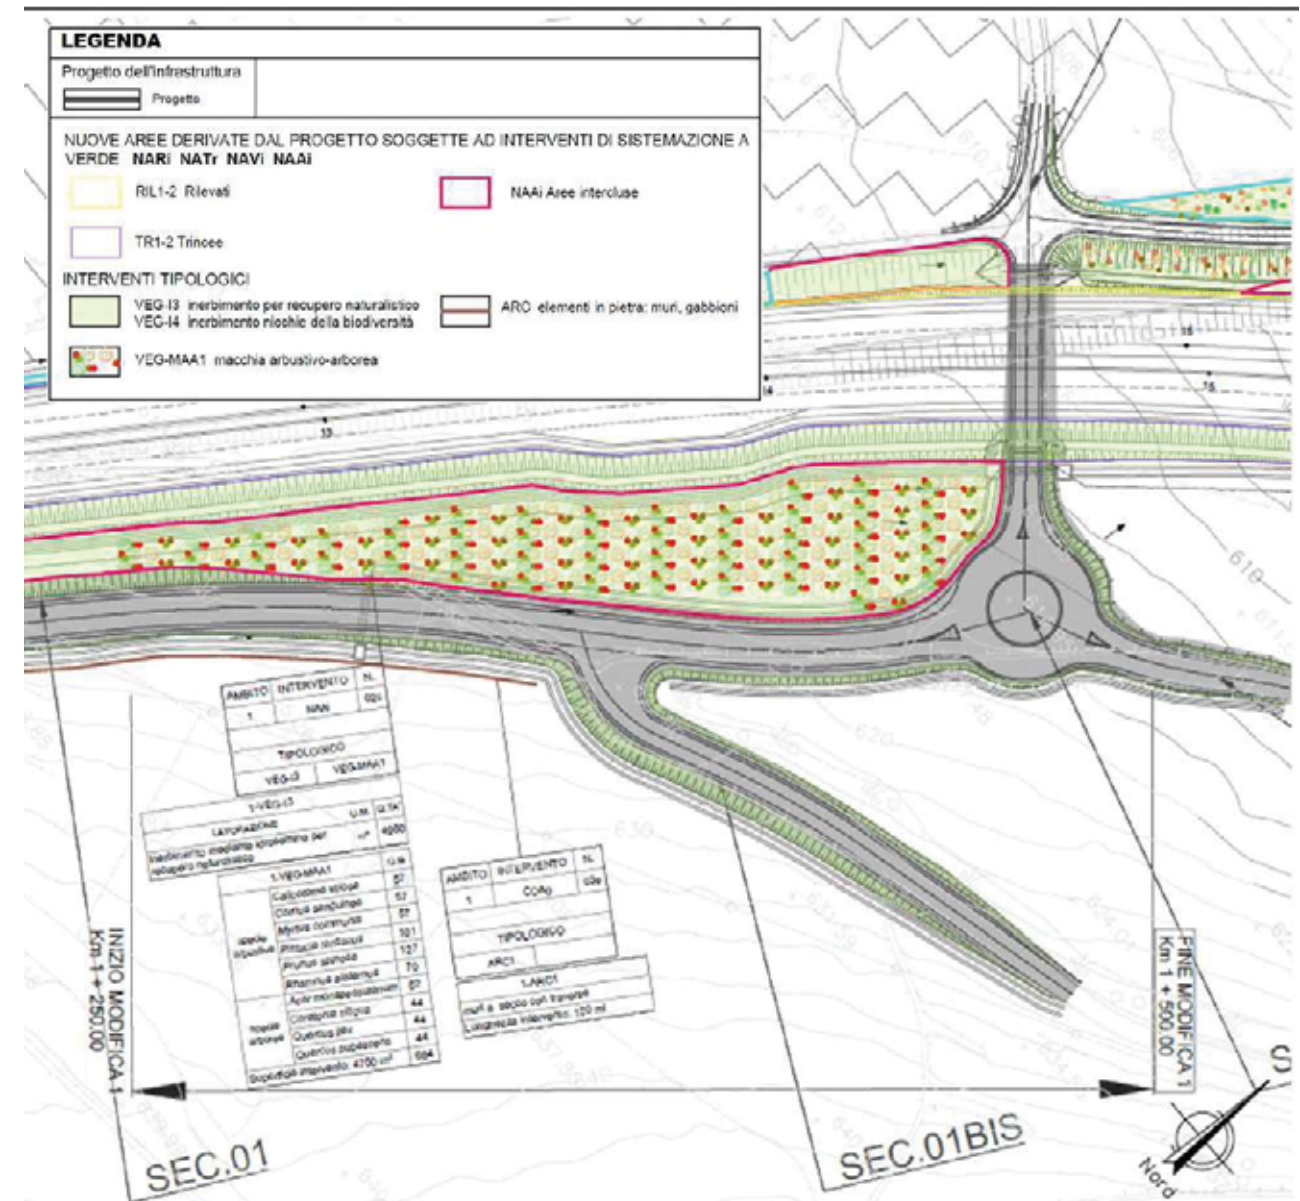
Estratto non in scala della Planimetria con interventi di mitigazione
